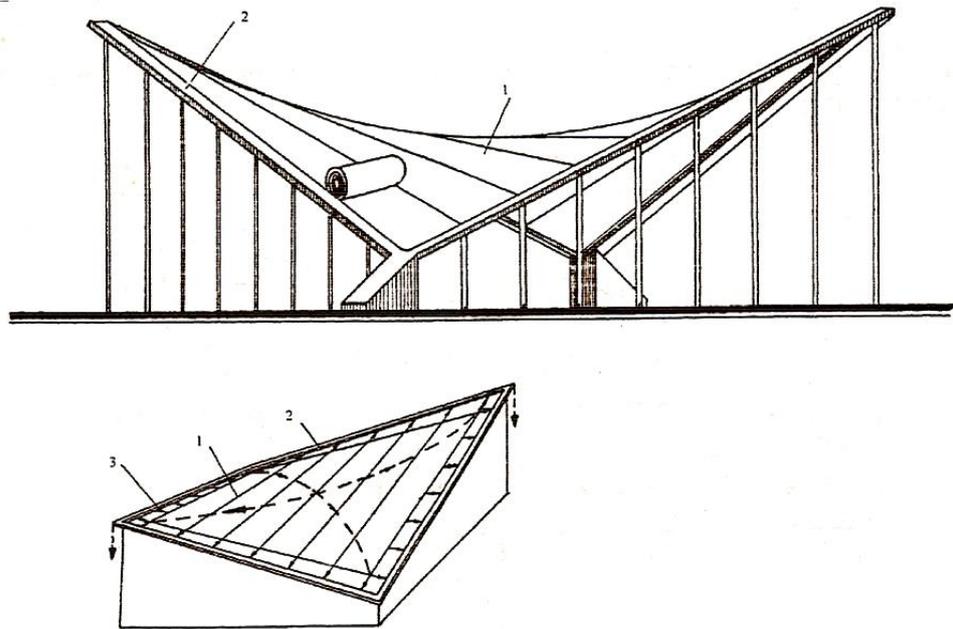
Мембранное покрытие отрицательной гауссовой кривизны на прямоугольном плане
